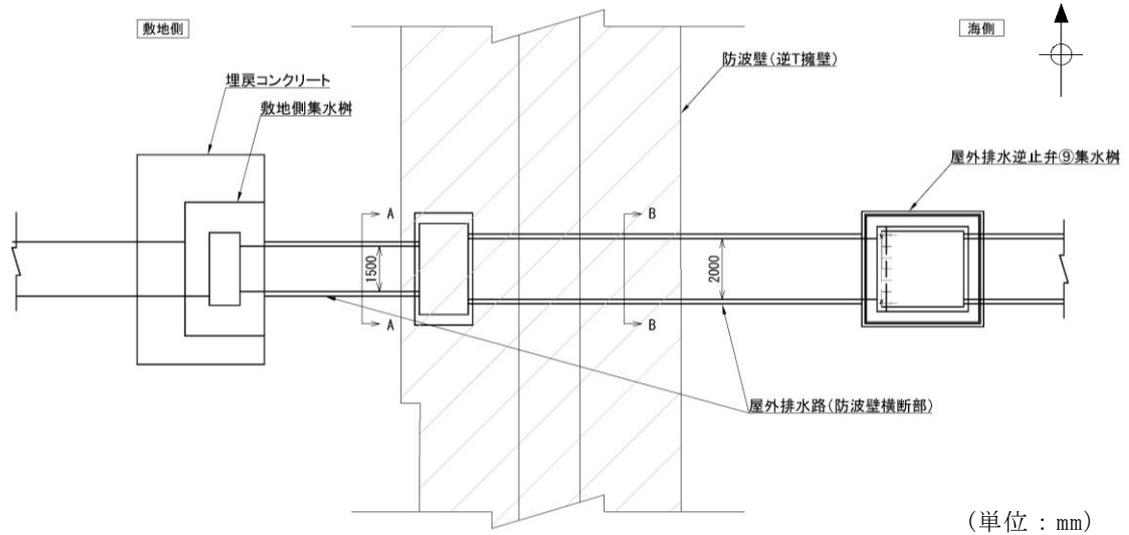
屋外排水路（防波壁横断部）の概略平面図
